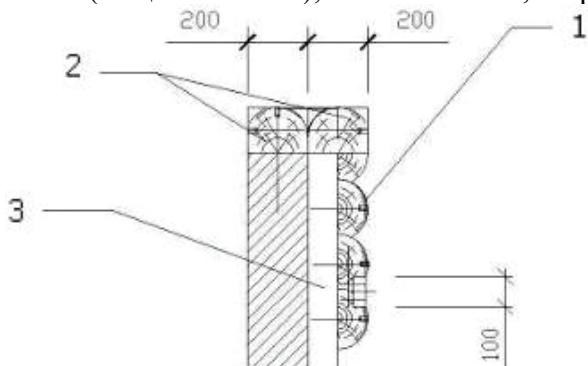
Узел крепления стенки железобетонного мельничного лотка к фундаменту мельничного здания Шибаевского пруда: 1 – стенка лотка из оцилиндрованного бревна Ø 200 мм; 2 – брус 150x200 мм; 3 – закладная деталь
